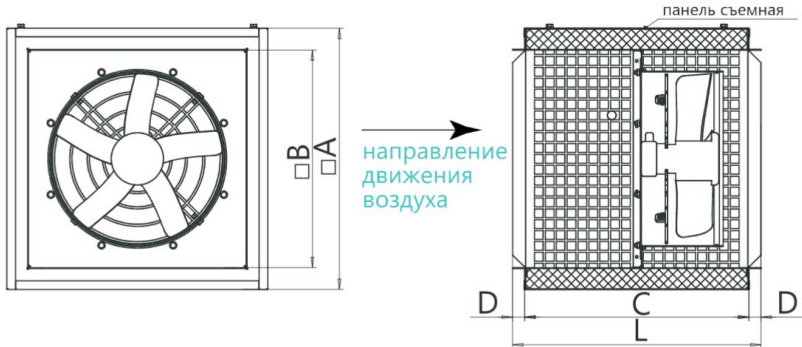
Габаритные, присоединительные и установочные размеры вентиляторов Канал-С-OZA-S
